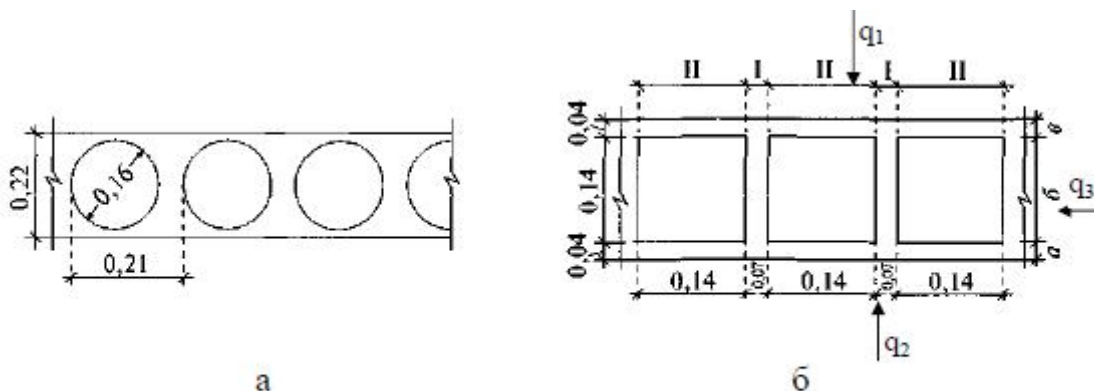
Поперечное сечение плиты (а) и расчетная схема (б)
